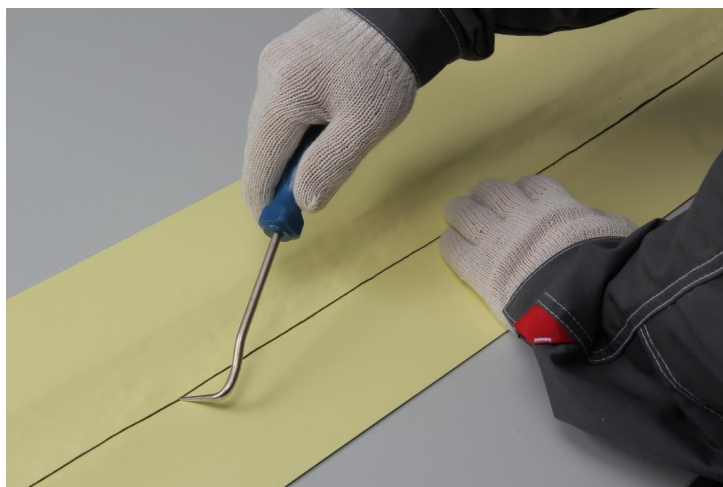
Проверка герметичности сварного шва вручную.
